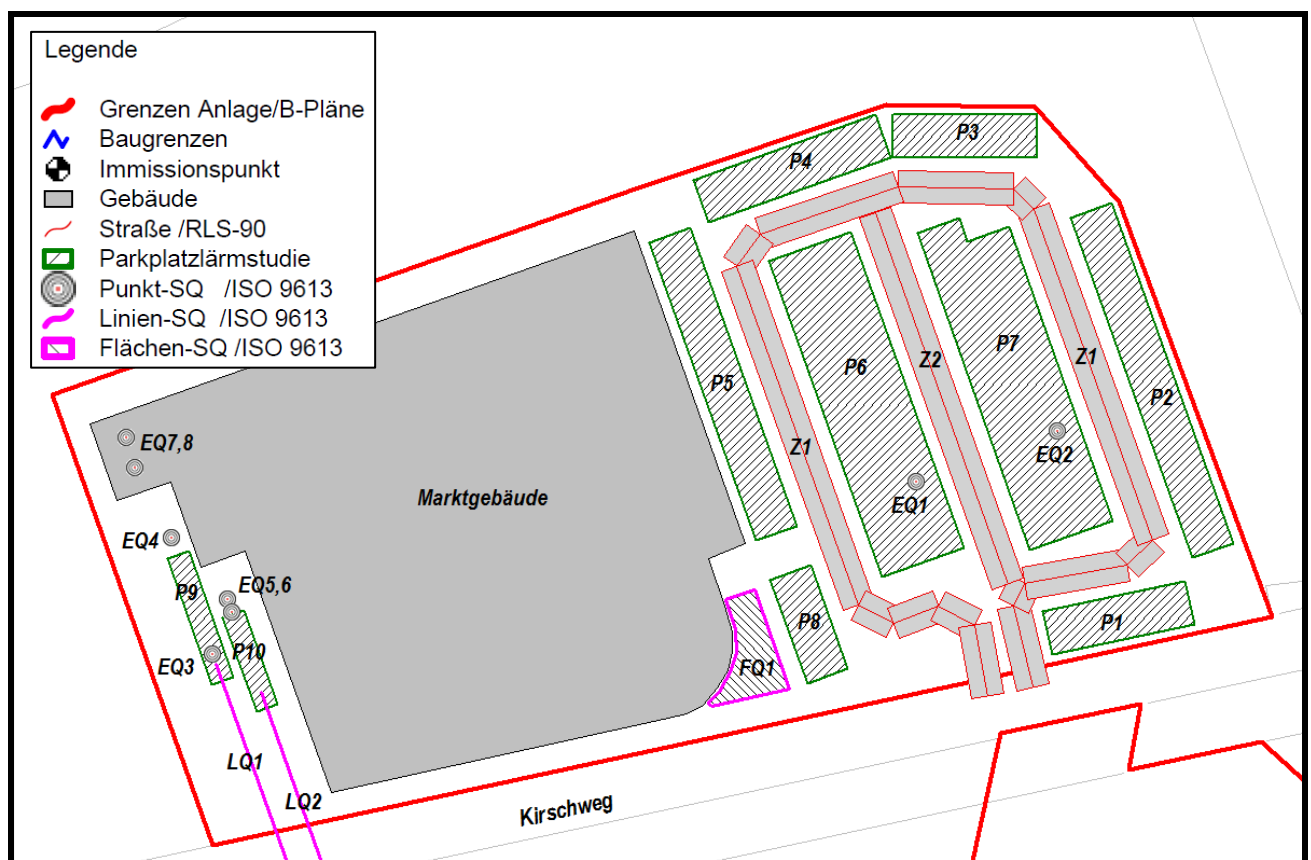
Lageplan Schallquellen gemäß Planstand /1/
